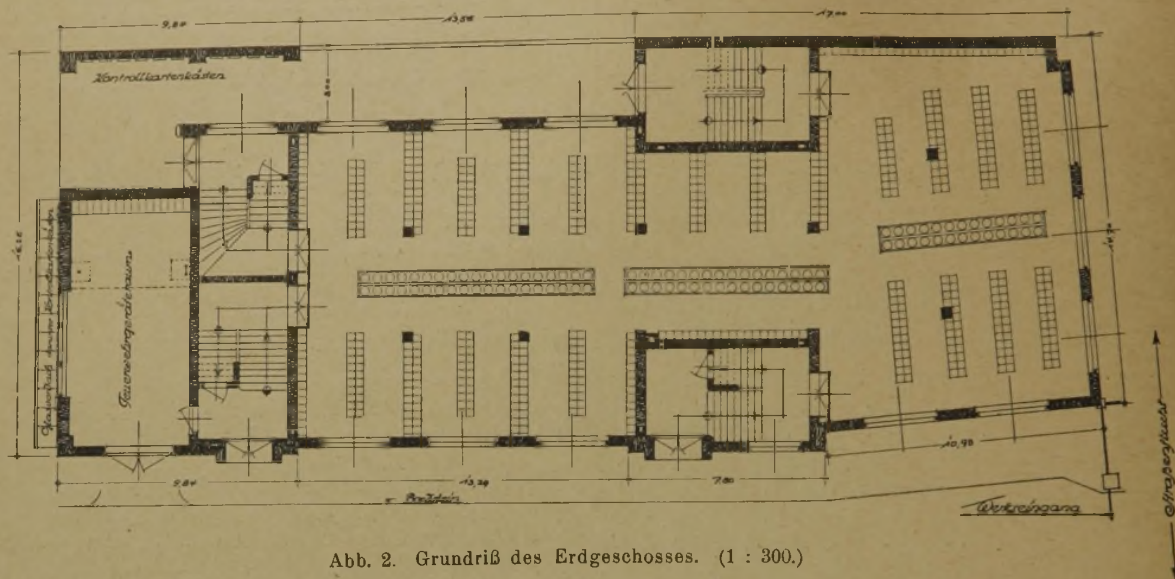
Grundriß des Erdgeschosses. (1 : 300.)
